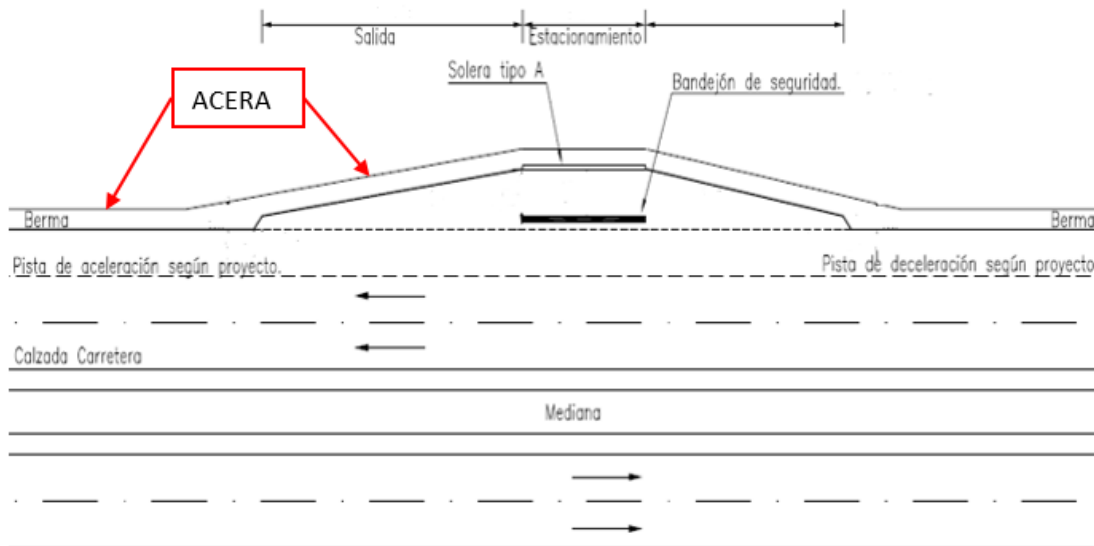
Vista en planta sector acera peatonal y su elemento a valorizar.
